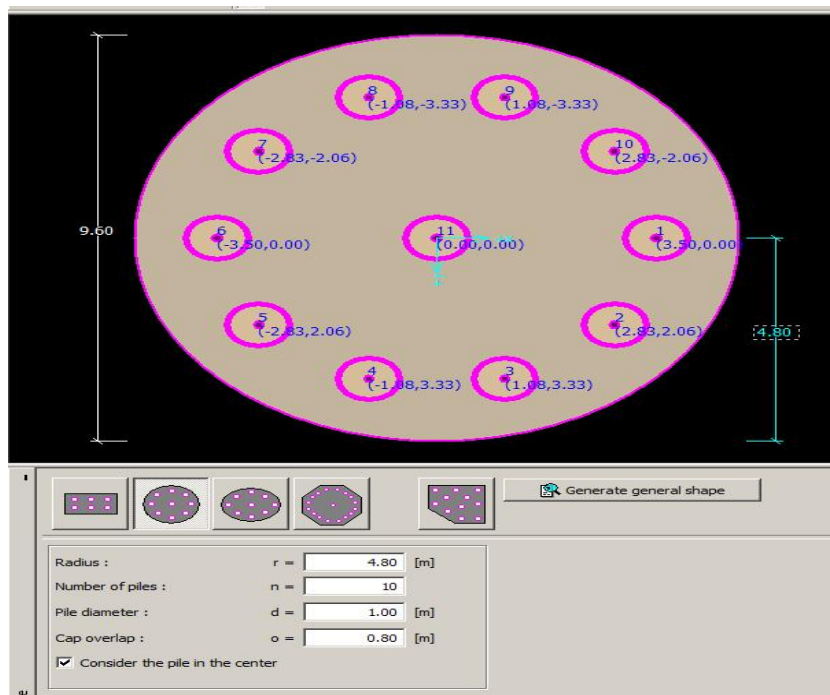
Disposition des pieux de la tour 4(Geo5 pile groupe).
